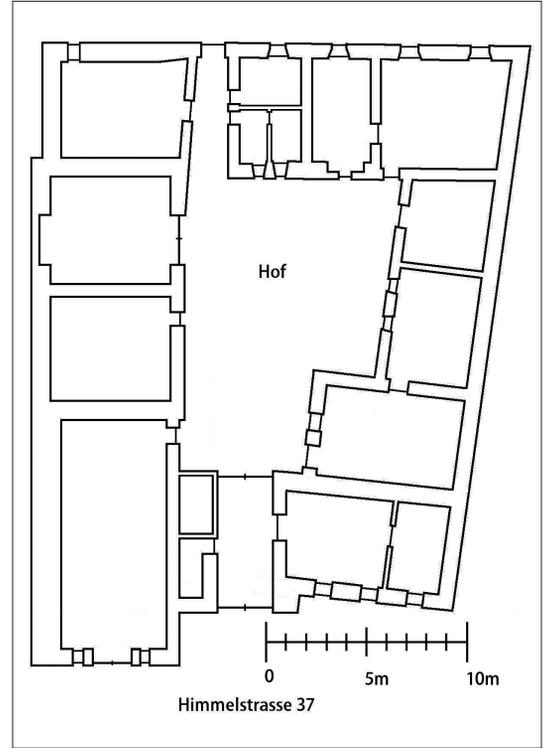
Grinzing, Himmelstraße 37, Grundriss des Erdgeschosses
